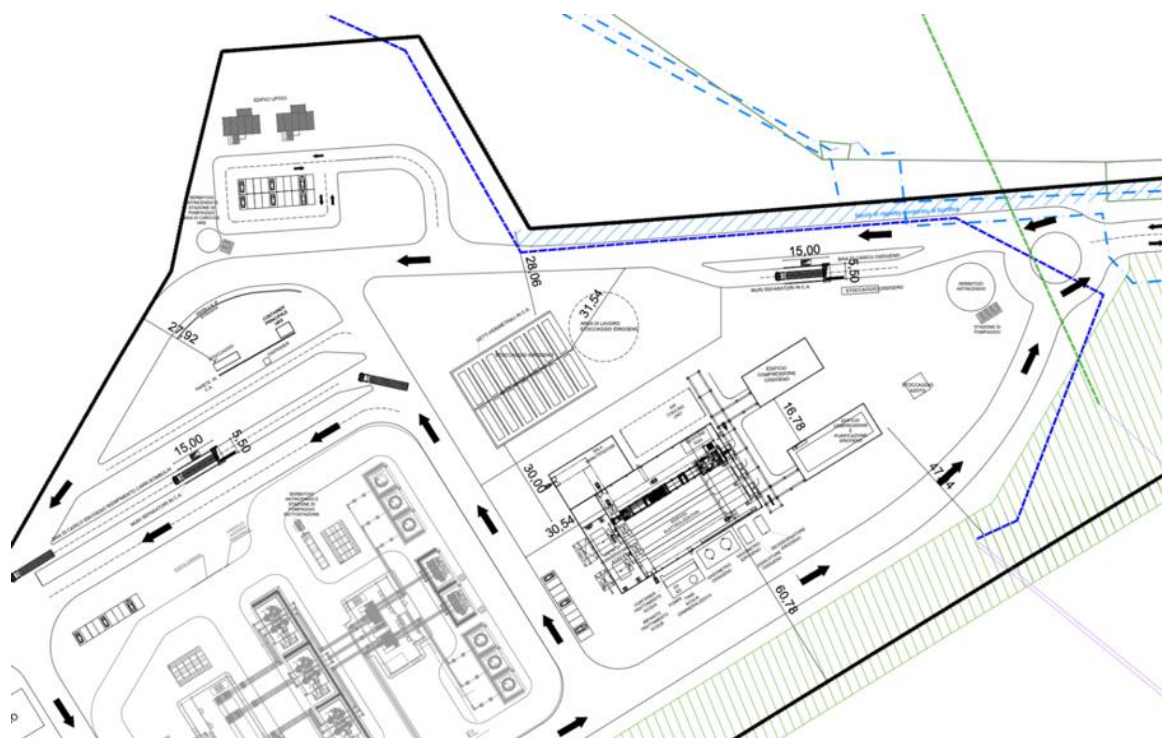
Planimetria impianto di produzione e stoccaggio idrogeno
